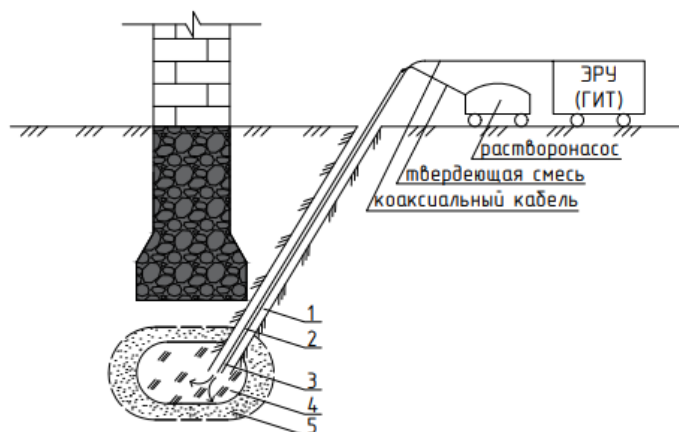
Схема устройства буроинъекционных свай для закрепления грунтов под подошвой фундамента.
